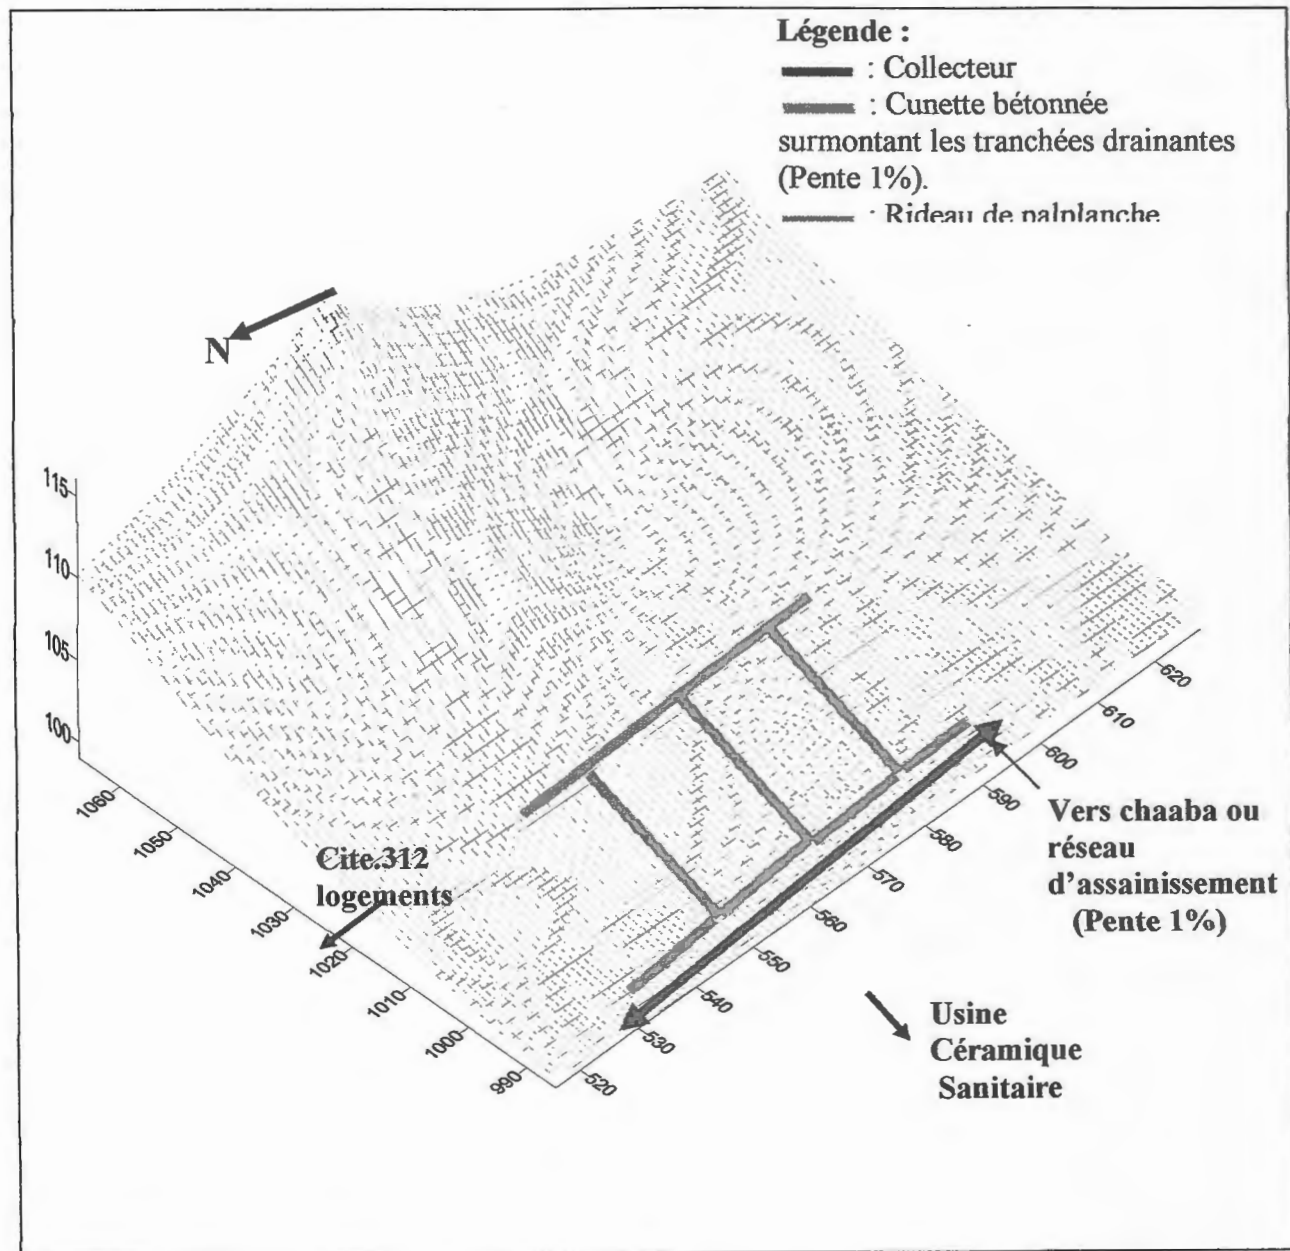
Vue en plan de la mise en place des solutions proposés (Drainage et palplanches)
